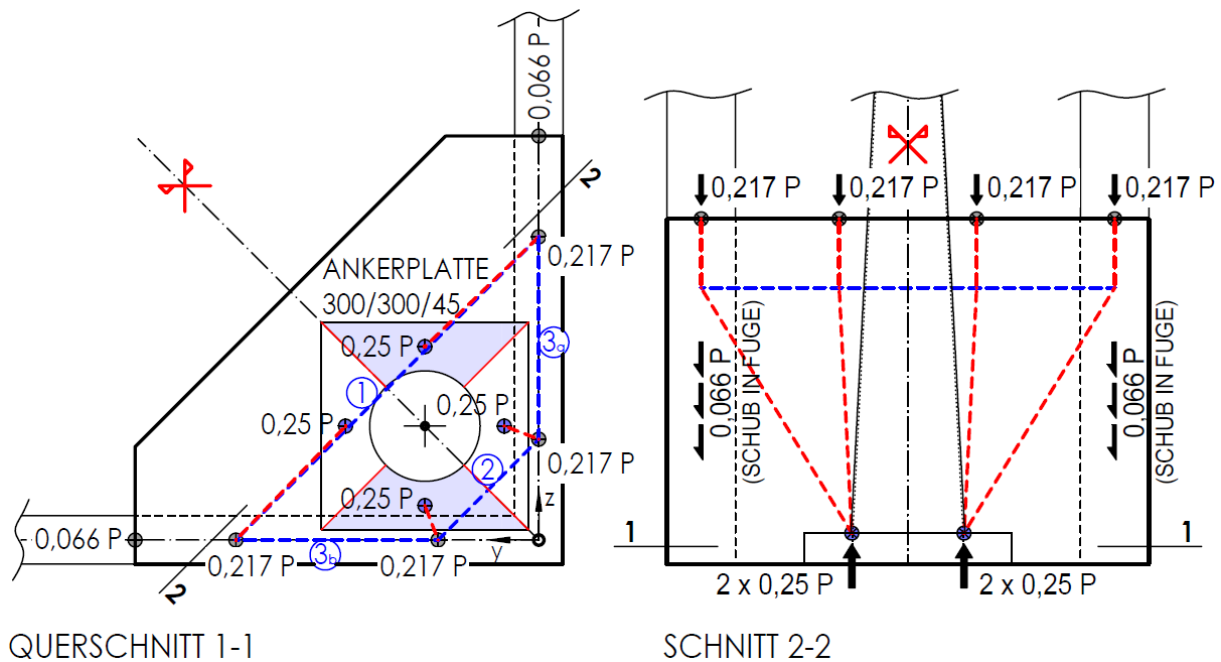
Geometrie Stabwerkmodell Variante 1 (rot: Druckstreben, blau: Zugstreben)
